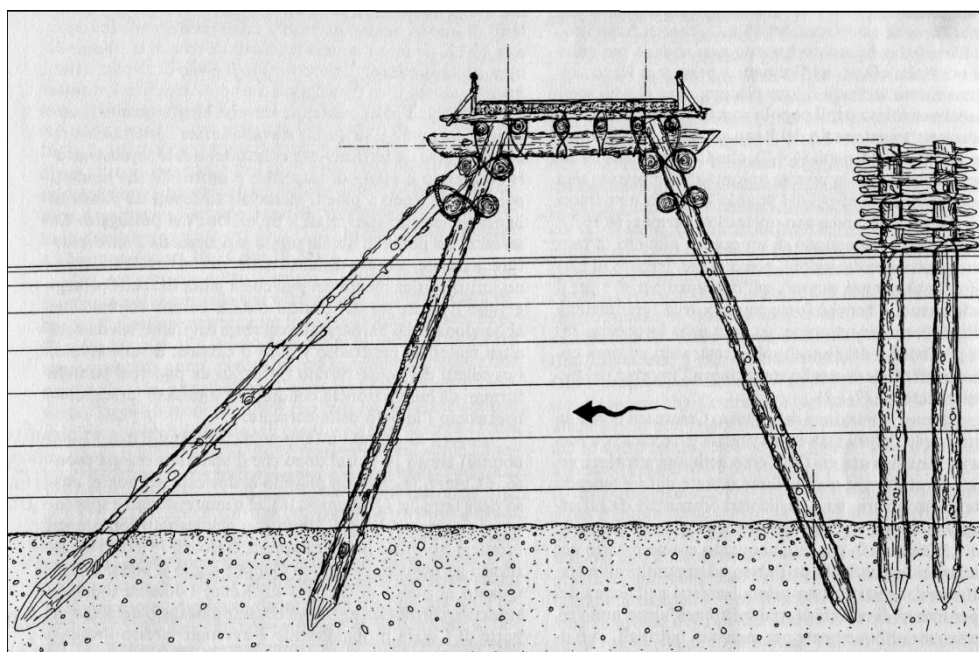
Corte lateral e planta de uma das secções da mesma Ponte sobre o Reno, ainda segundo Galliazzo.
